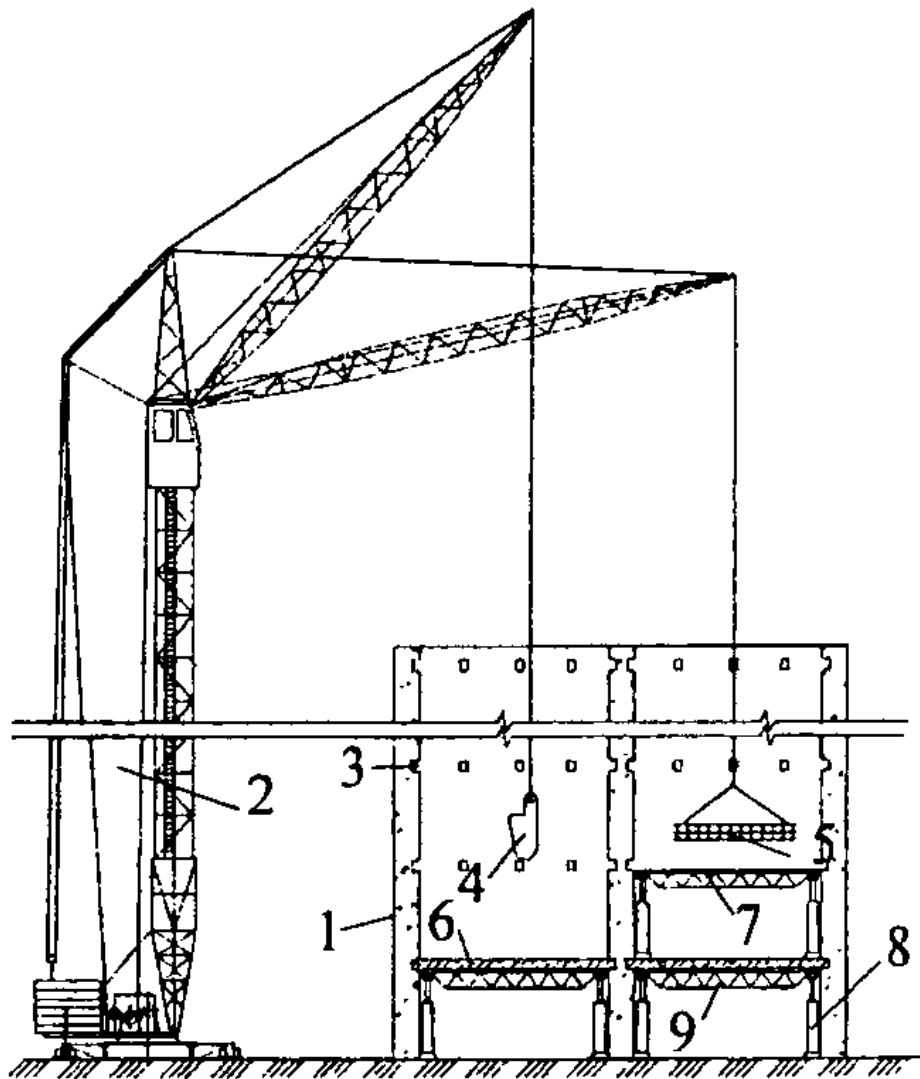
Бетонування міжповерхового перекриття методом «знизу-вгору»: 1 — монолітні стіни; 2 — кран; 3 — залишені при бетонуванні гнізда; 4 — поворотна баддя для подачі бетонної суміші; 5 — армокаркас; 6 — опалубка перекриття; 7 — фермочний прогін; 8 — телескопічна стійка; 9 — монолітне перекриття
